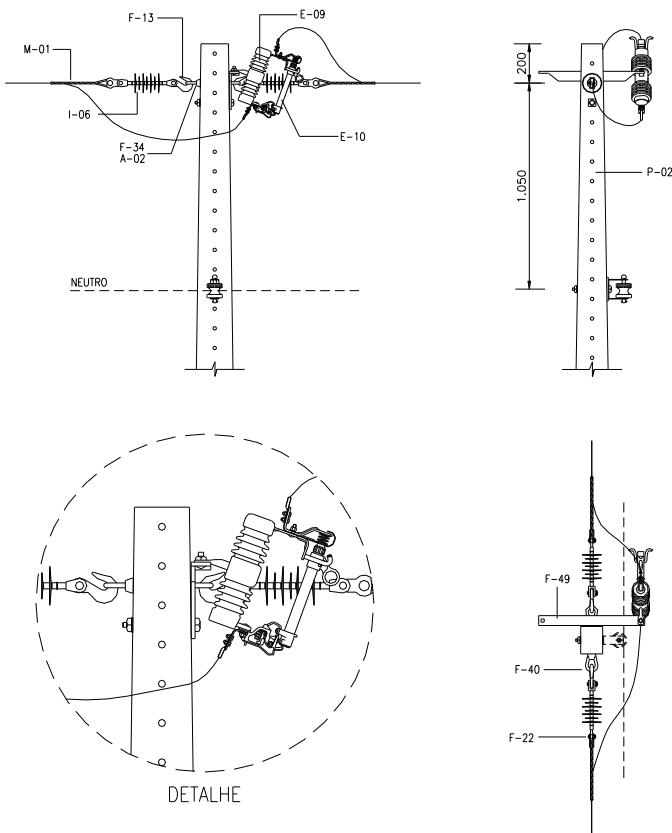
Instalação de equipamentos – Ch.Fus.Monof.U4
